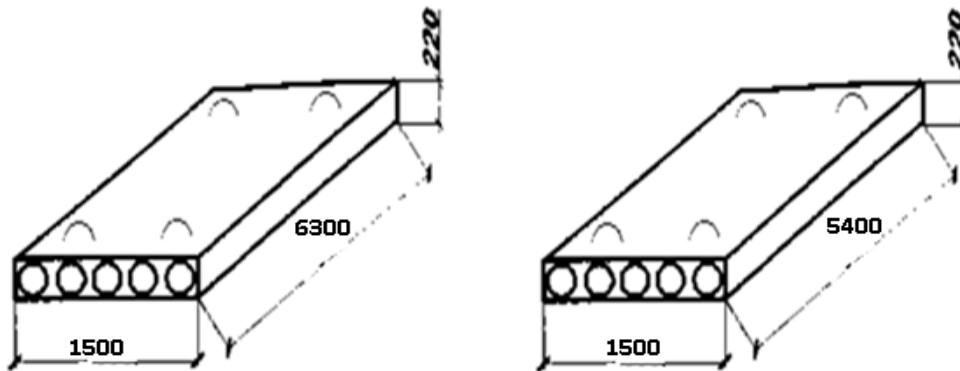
Залізобетонні плити перекриття та покриття.
